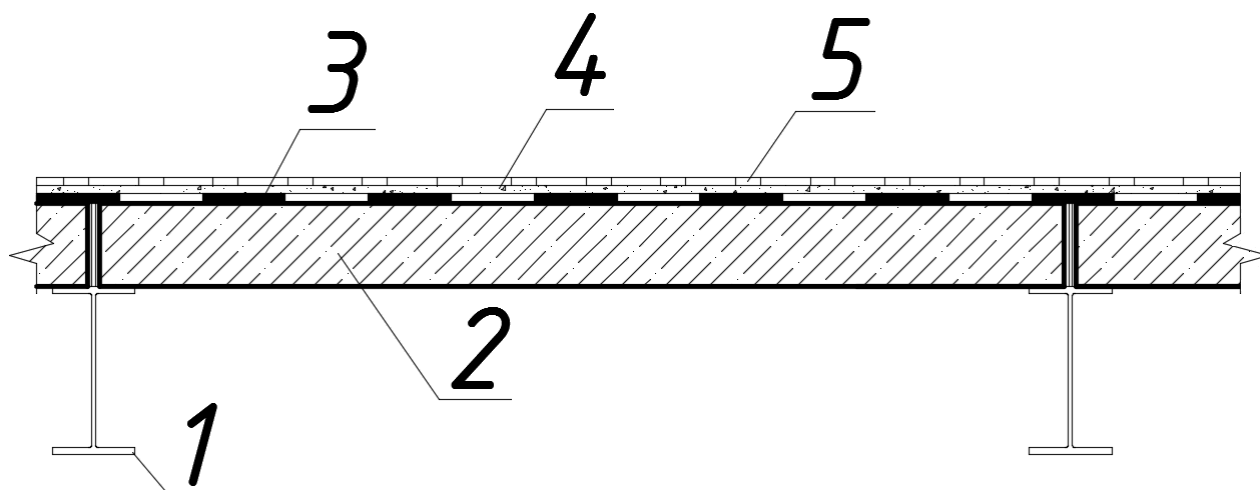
Конструкция междуэтажного перекрытия из стальных двутавровых балок с заполнением плоскими железобетонными плитами
